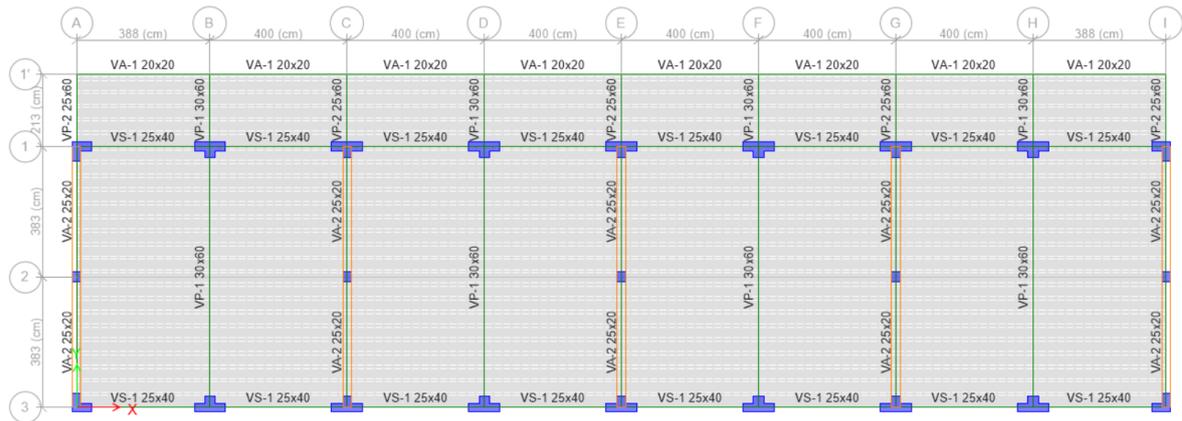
Elementos estructurales primer piso y segundo piso Bloque 02
